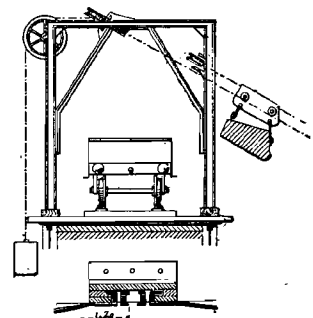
et 5. — Elévation de la charpente qui porte les poulies du câble métallique servant au transport des matériaux et coupe horizontale des palplanches métalliques qui entourent les fondations des piles.
